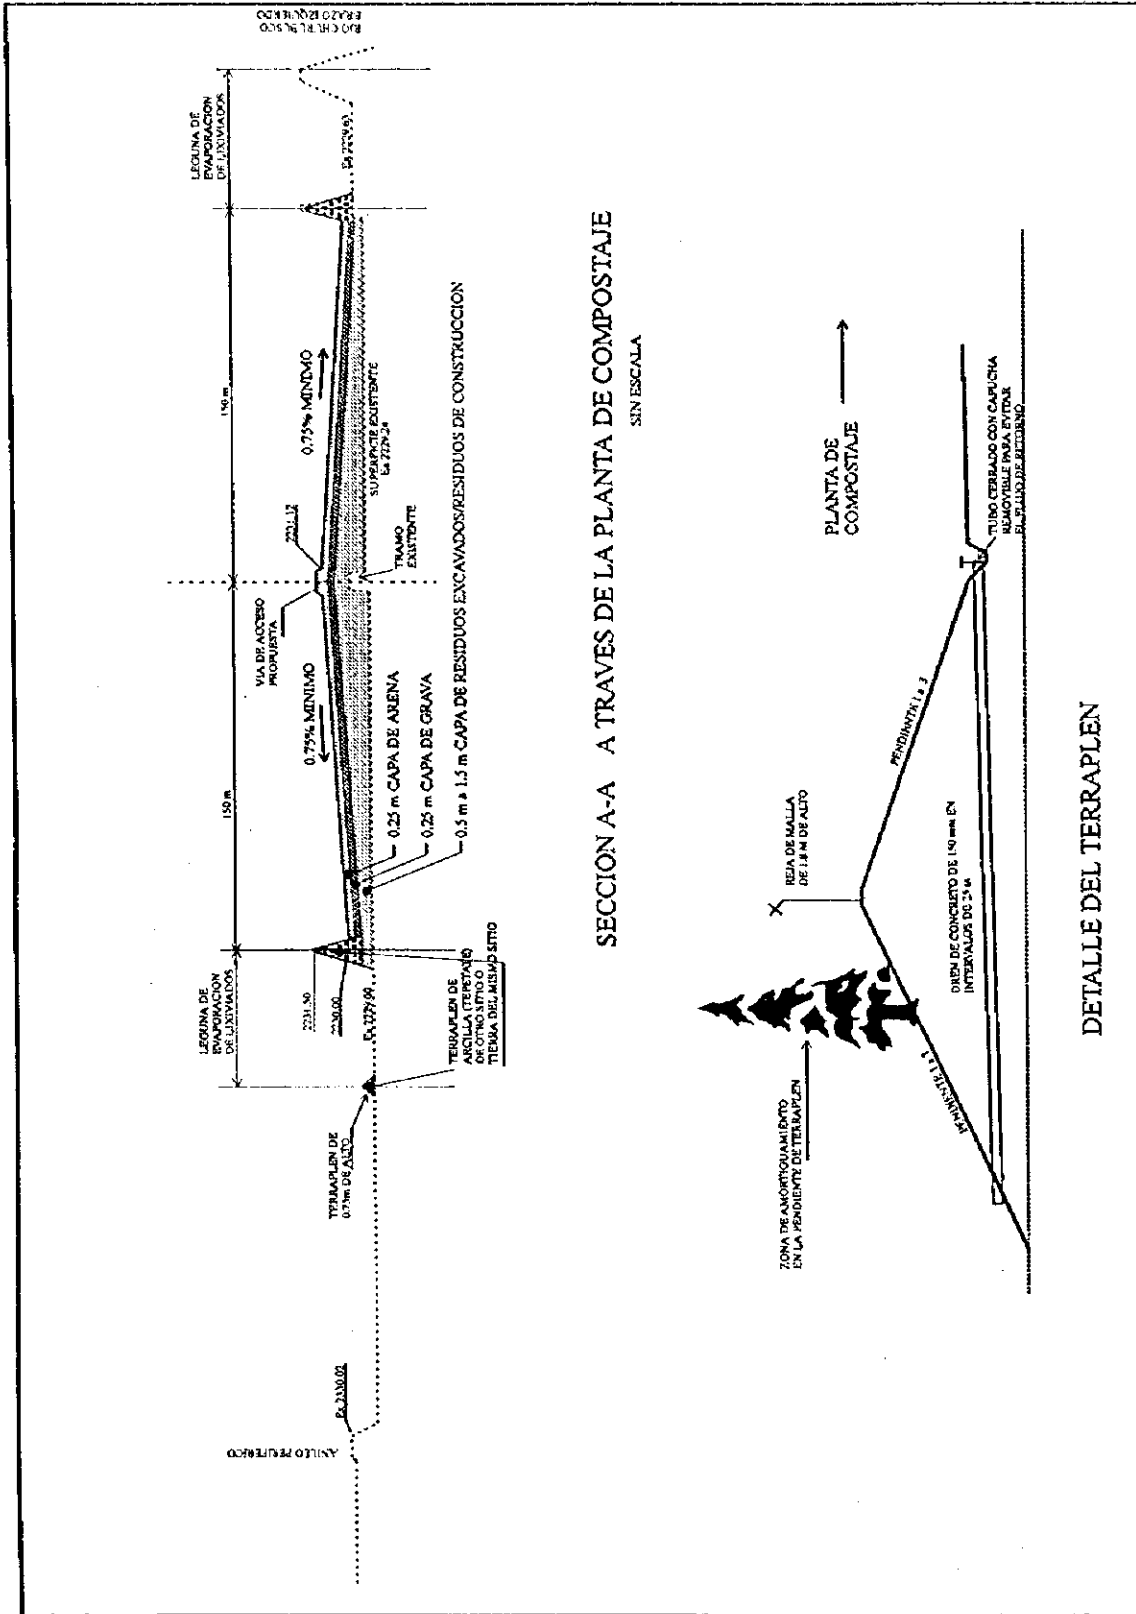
Corte Transversal A-A de la Planta de Compostaje Propuesta
